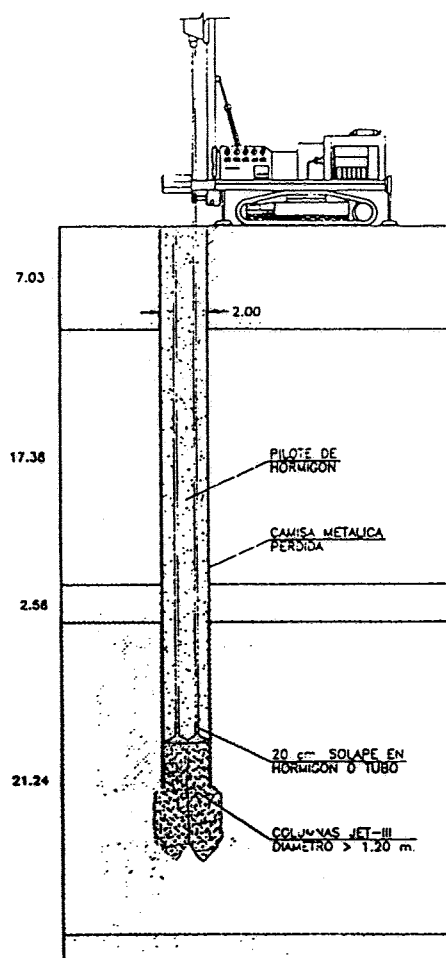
Tratamiento mediante Jet-Grouting de la punta de un pilote.
